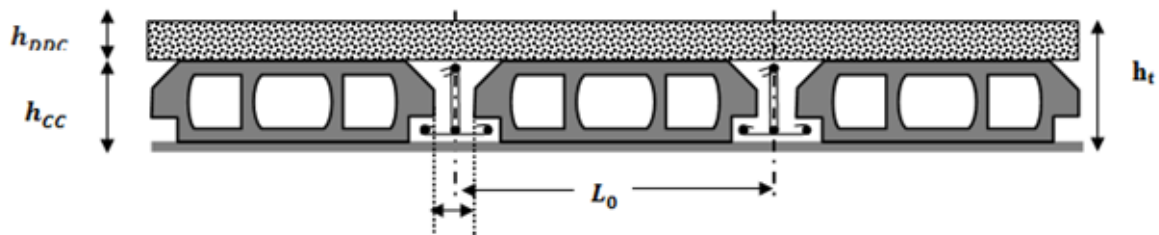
Coupe transversale sur un plancher à corps creux.
